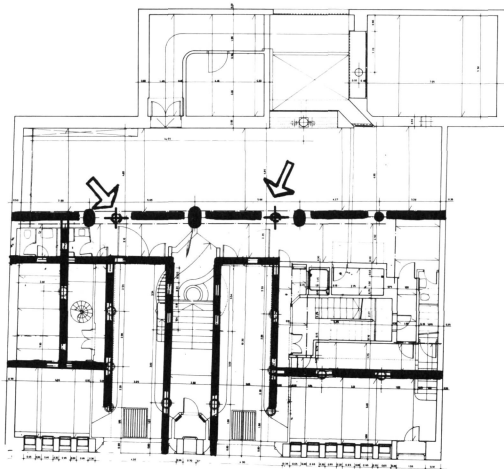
Los dos pilares que arrancan del techo de la planta baja.
